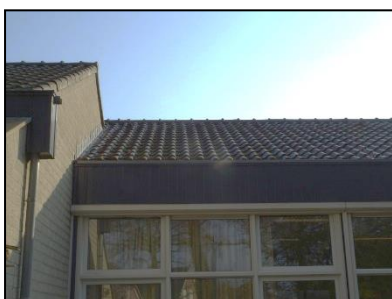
Vooraanzicht Jozefschool, gezien vanaf de noordwestzijde.
